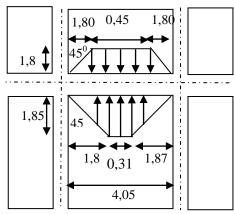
Répartition des charges sur les poutres selon Les lignes de rupture
